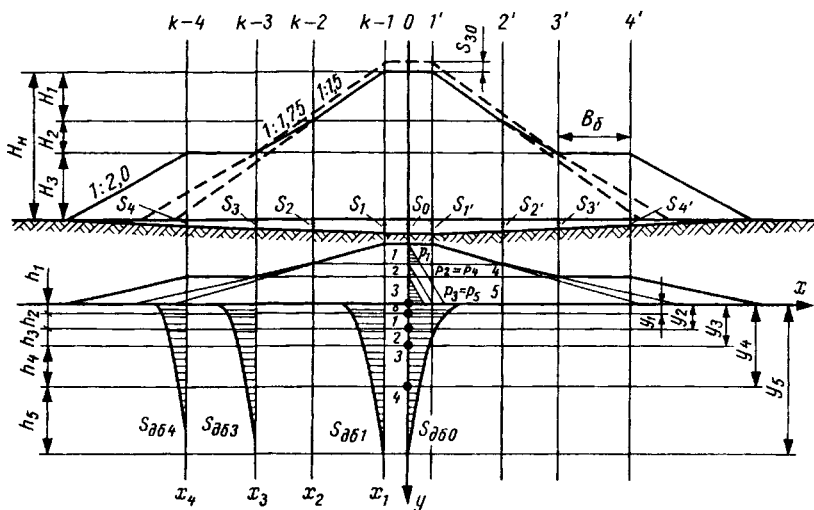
Расчетная схема для определения осадок основания насыпи
